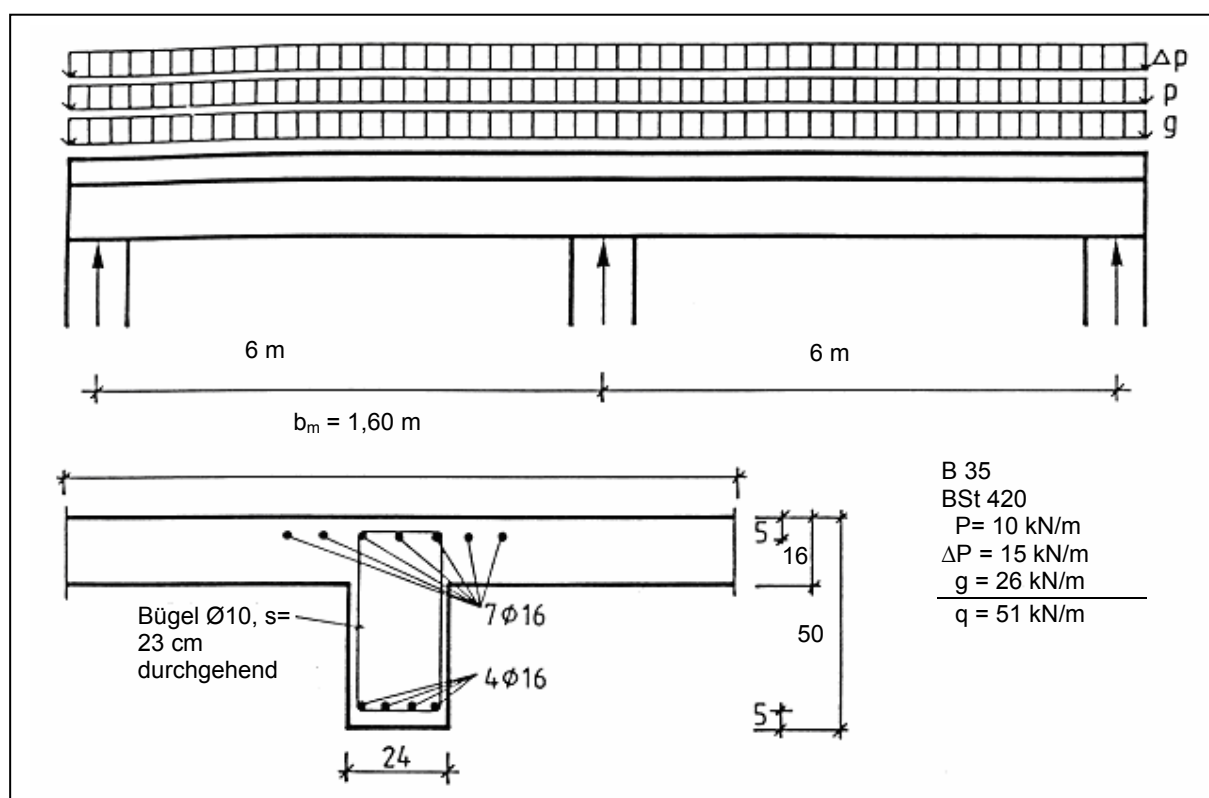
Unverstärkter Plattenbalken, Bewehrung, Baustoffe, Belastung [68]
